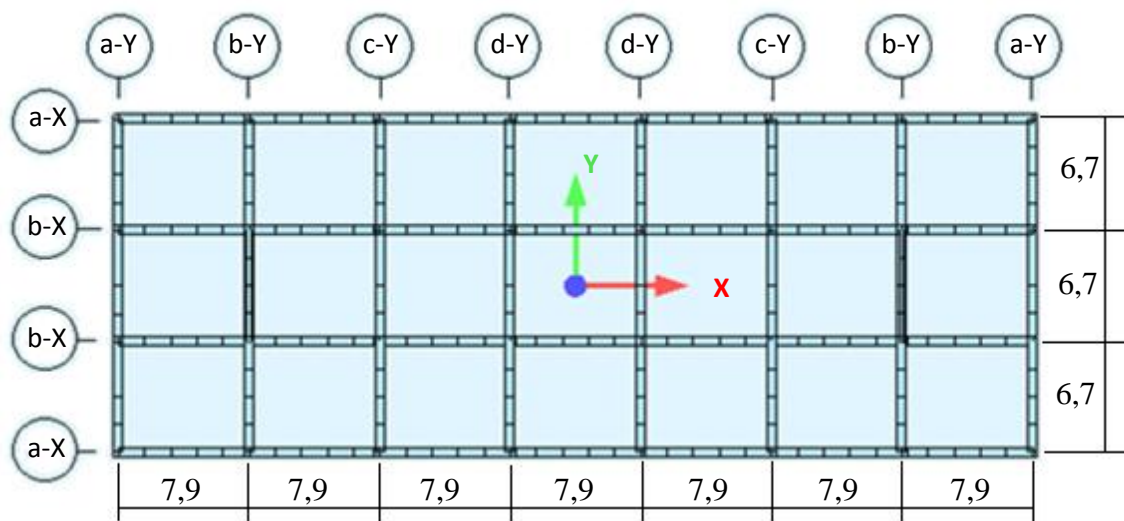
Planta baixa do pavimento tipo, dimensões em metros.
